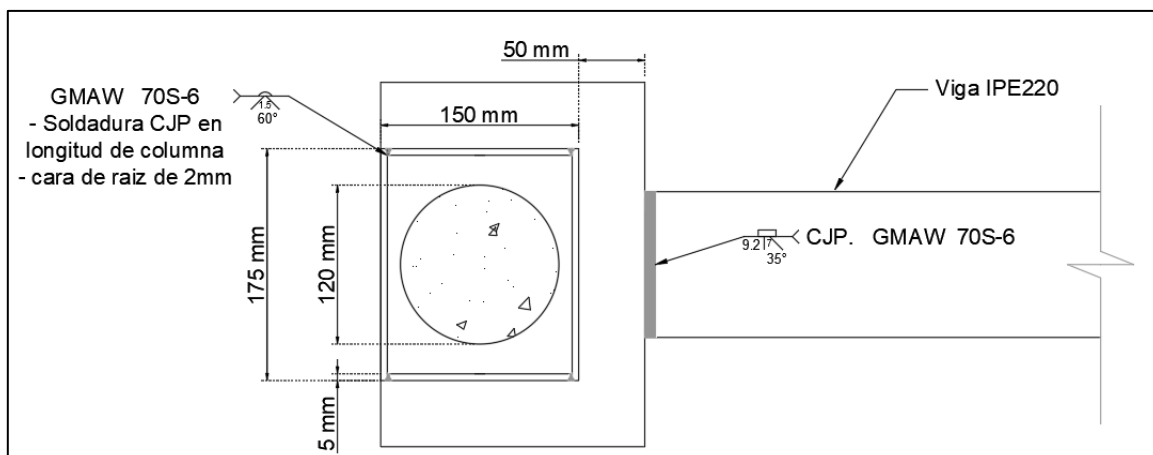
Vista en planta de detalles de soldadura en la conexión Viga-Columna.
